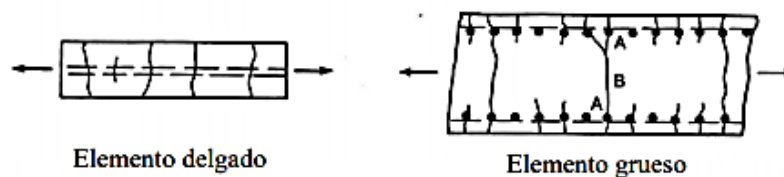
Grietas por esfuerzos de tracción directa
